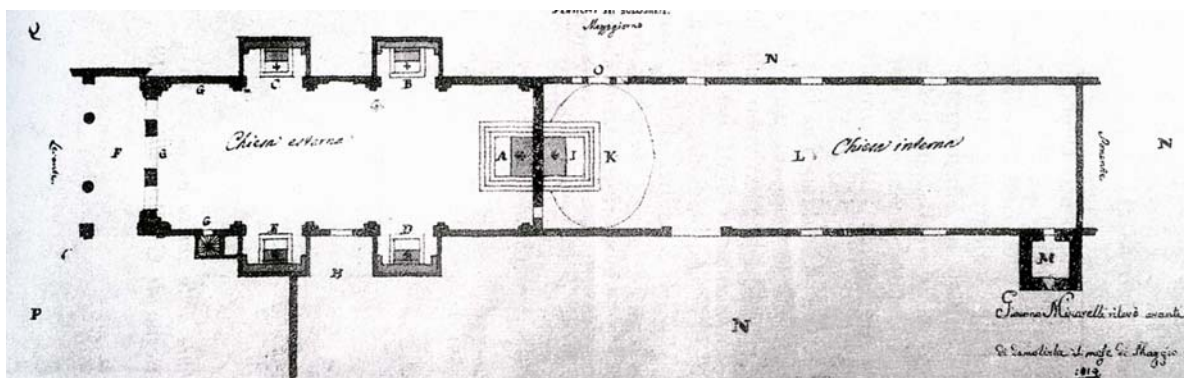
Bologna, S. Agnese, Grundriss
